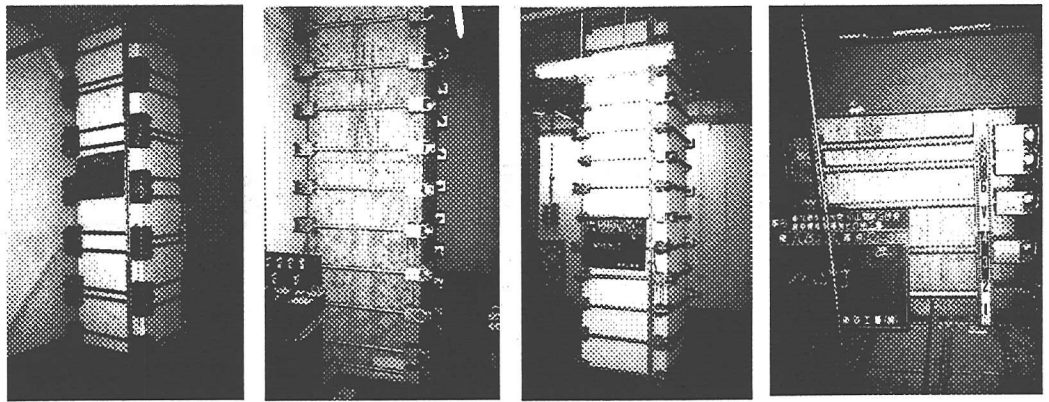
タイプ A 写真-11 タイプ B 写真-12 タイプ B+C 写真-13 タイプ A(天井裏)
